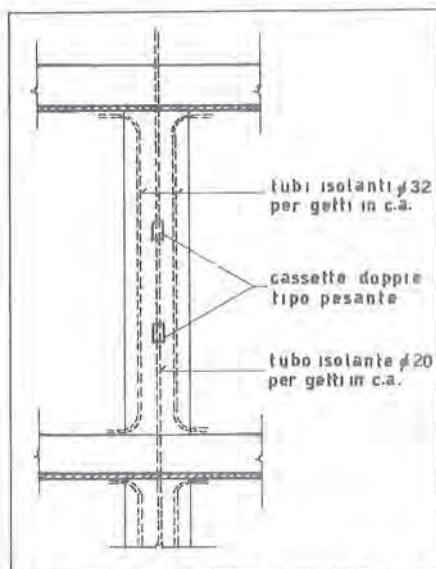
Autormessa del Centro Servizi della Cassa di Risparmio di Venezia. Particolare del pilastro attrezzato con tubazioni per impiantistica.
